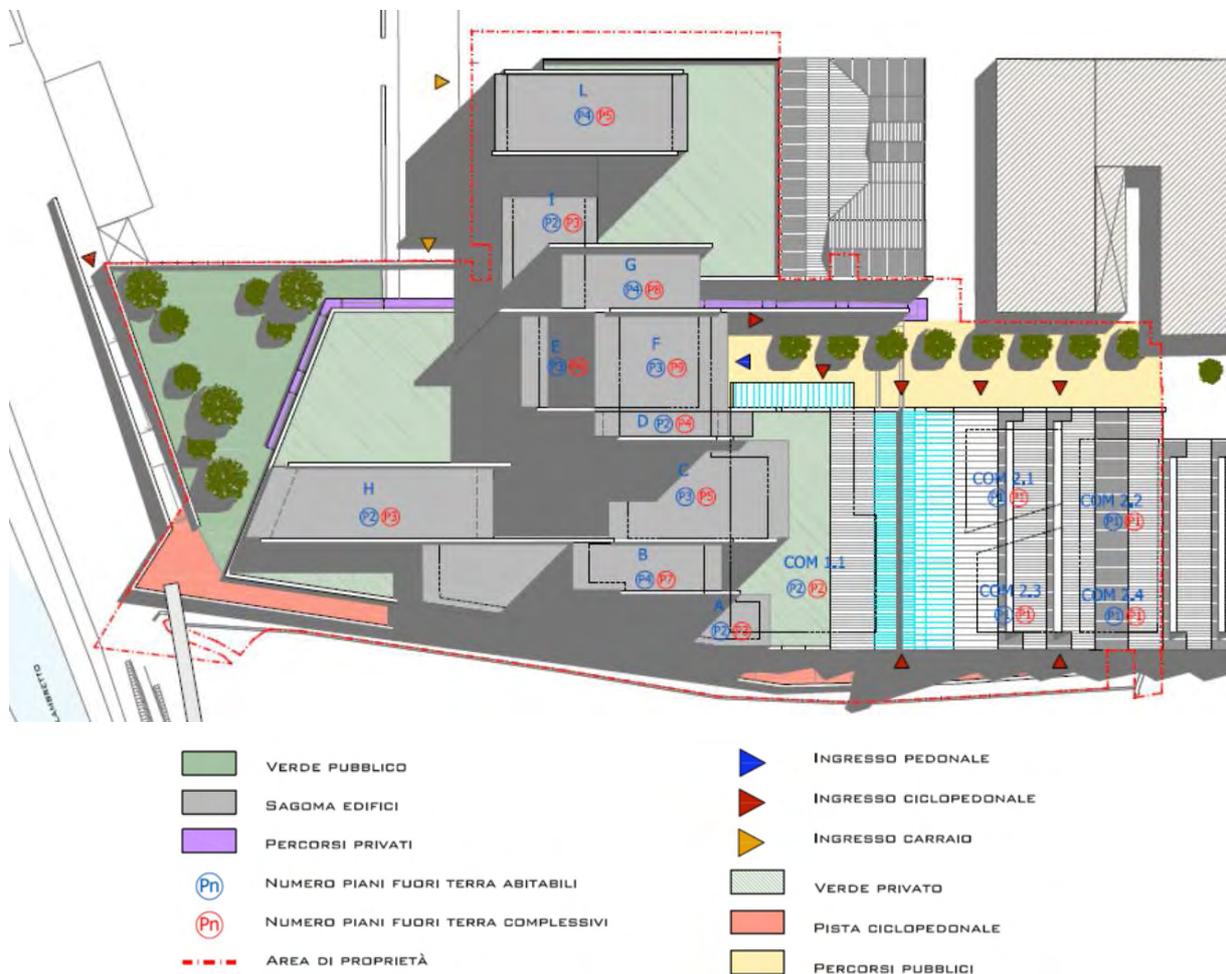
Planimetria dello *stato di progetto* con l'indicazione delle differenti aree (stralcio dell'elaborato D1)
